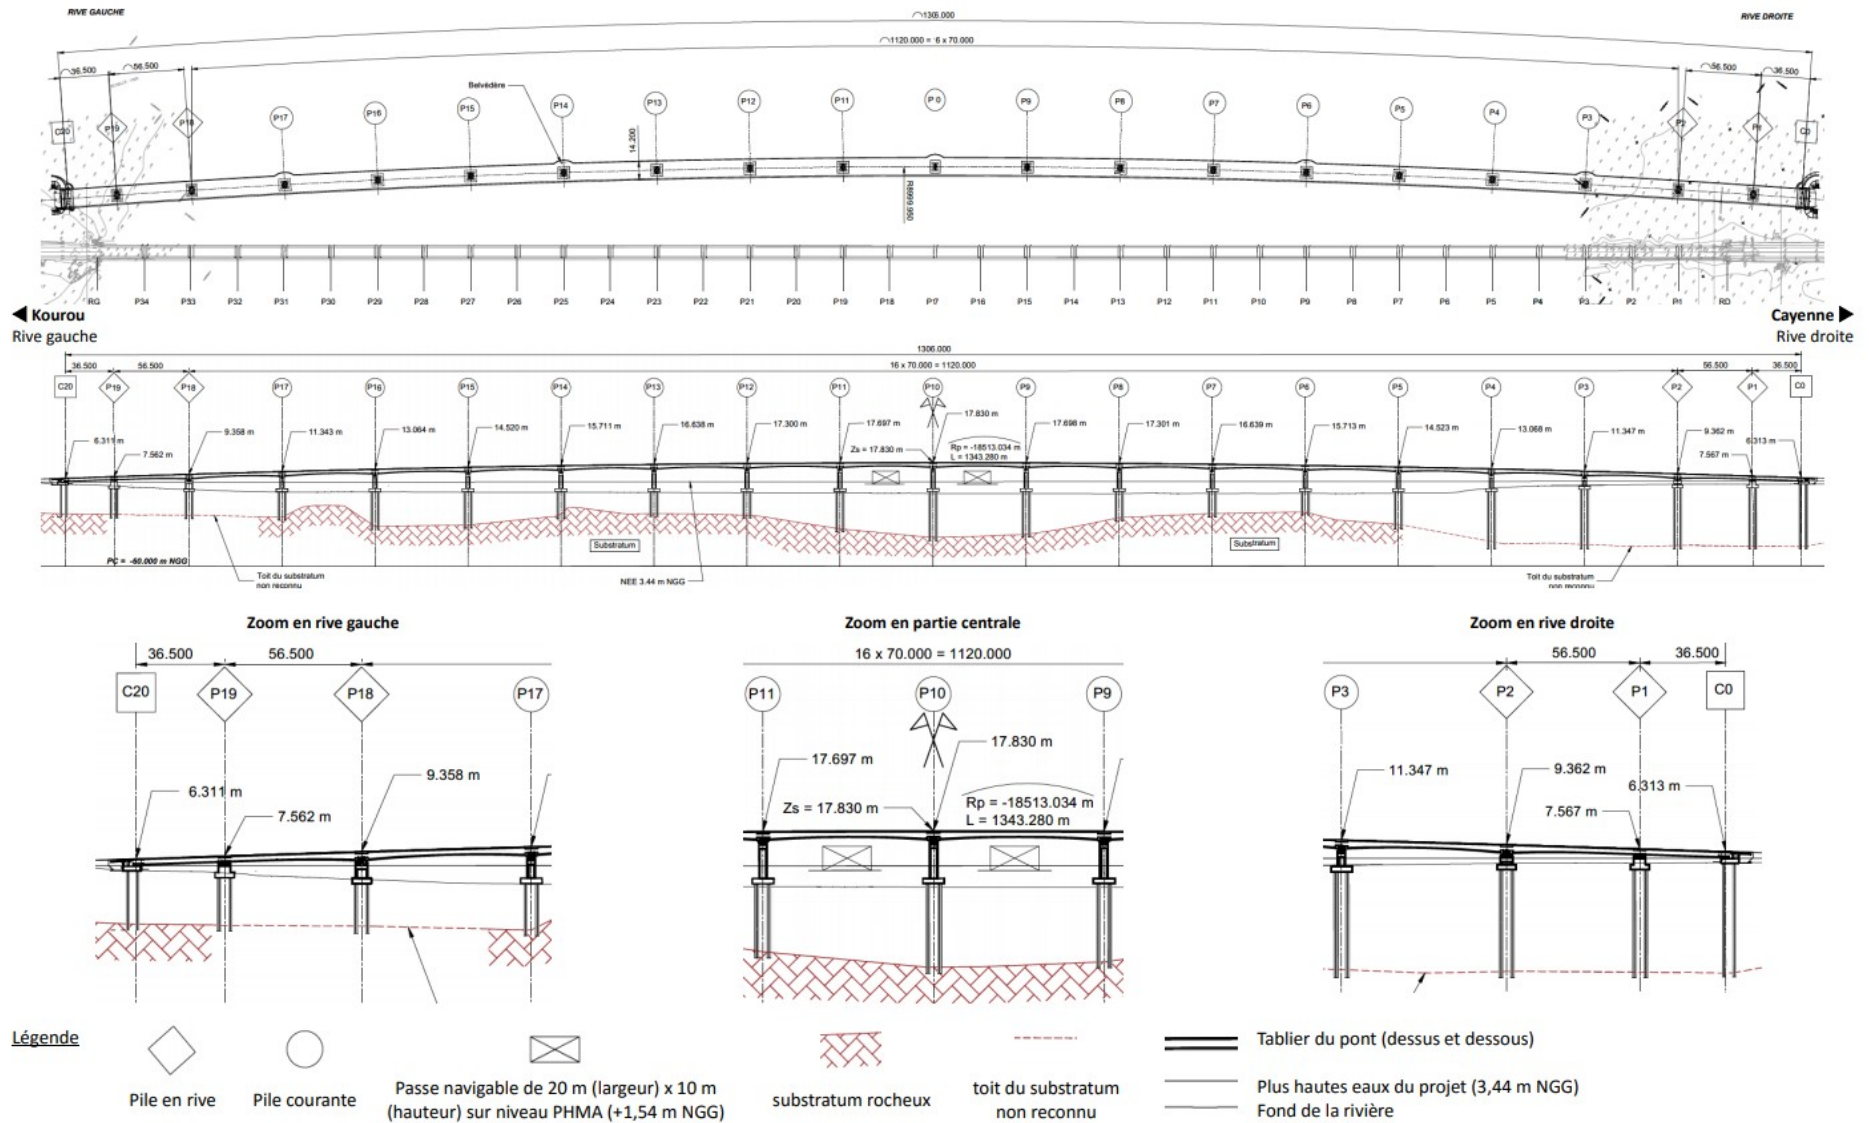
coupe longitudinale, solution avec tablier de hauteur variable
